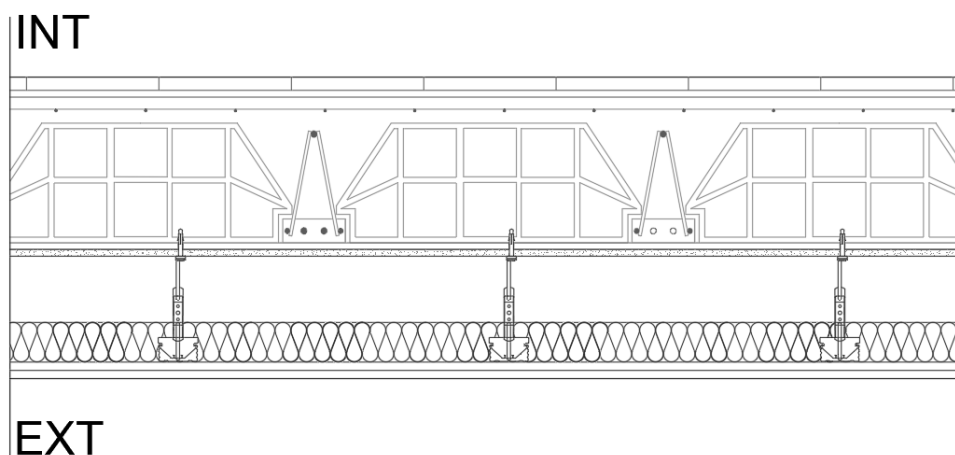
Detalle do forxado interior con falso techo suspendido e illante. Elaboración propia.
